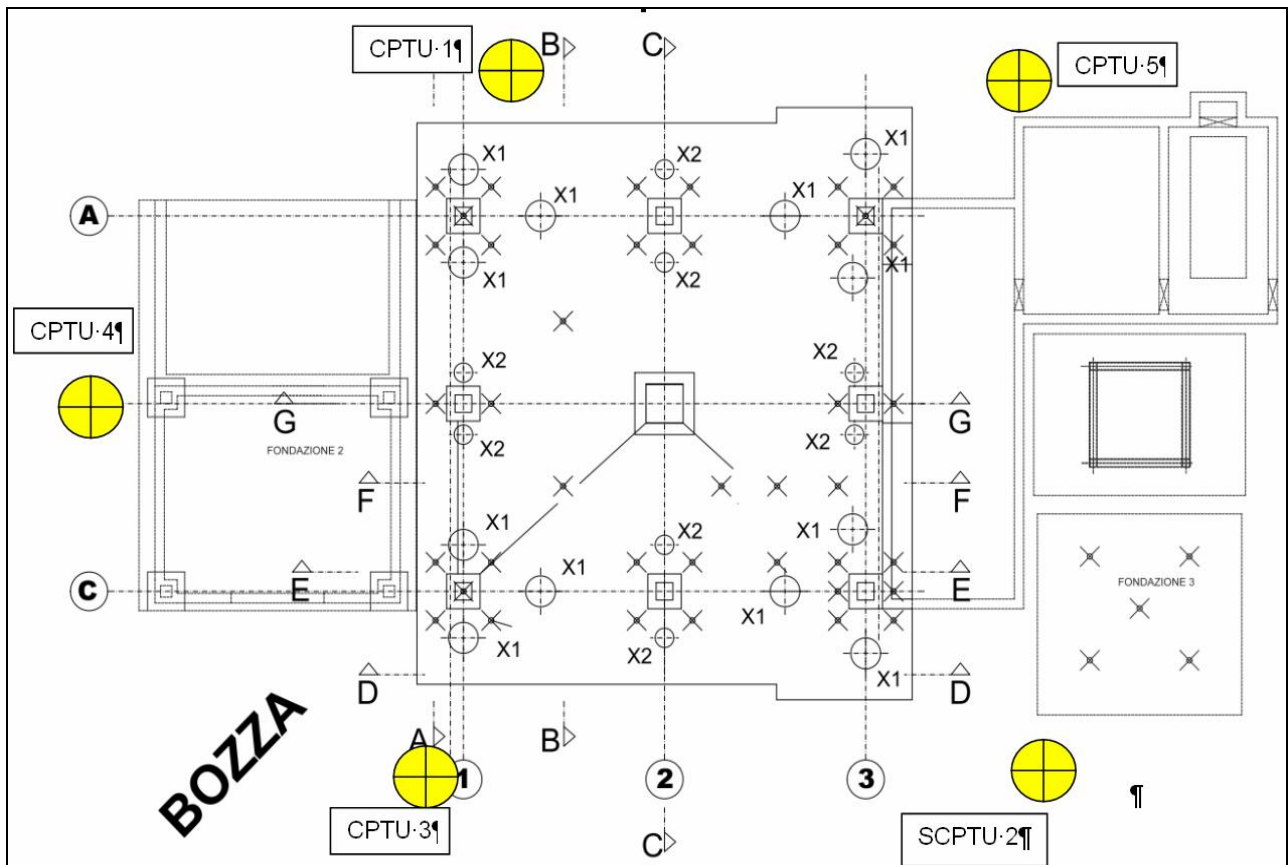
Stralcio di progetto con ubicazione prove
